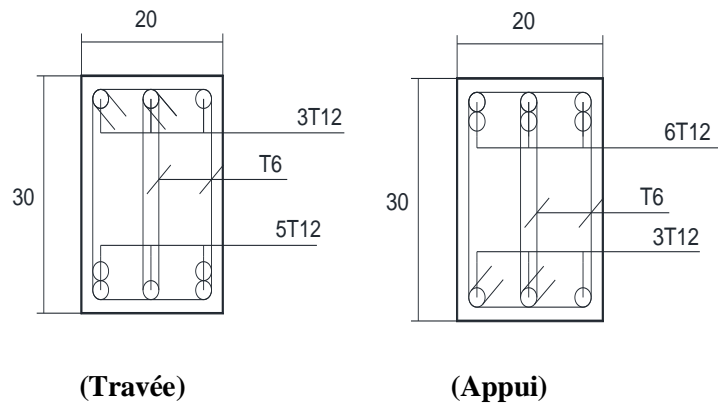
Ferrailage d'une poutre noyée secondaire 20x30cm (plan fortement irrégulier)
